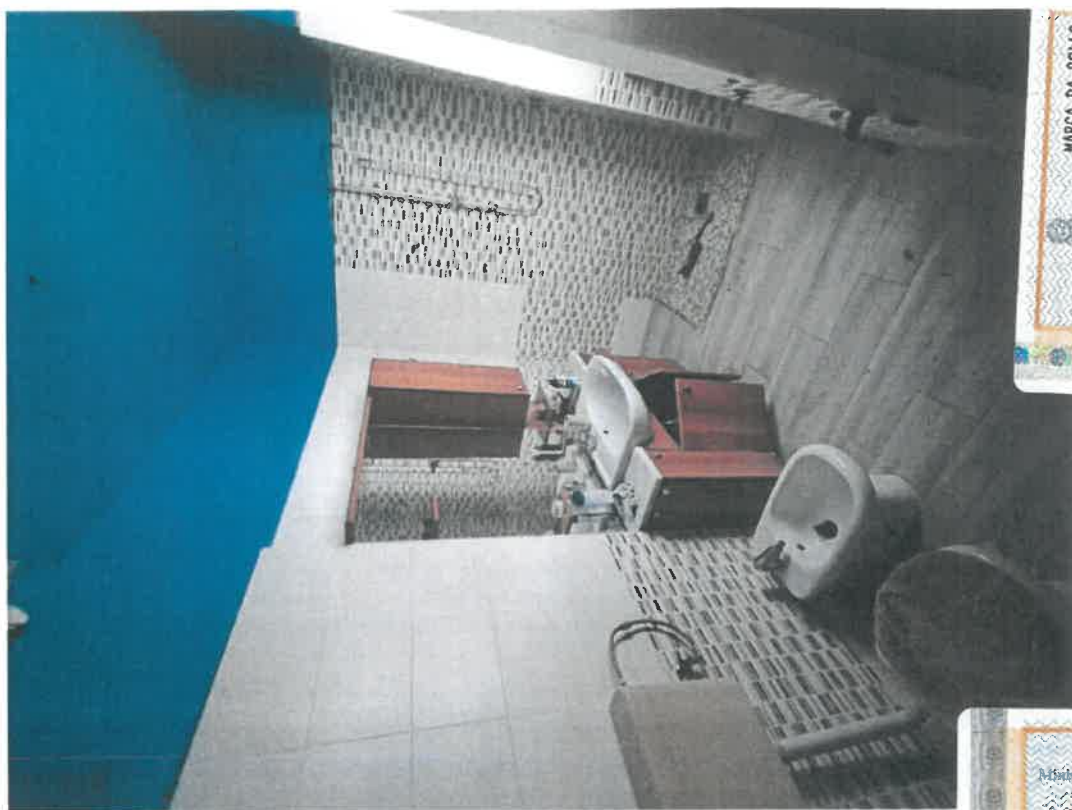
VISTA LOCALE BAGNO UBICATO AL PIANO TERRA
